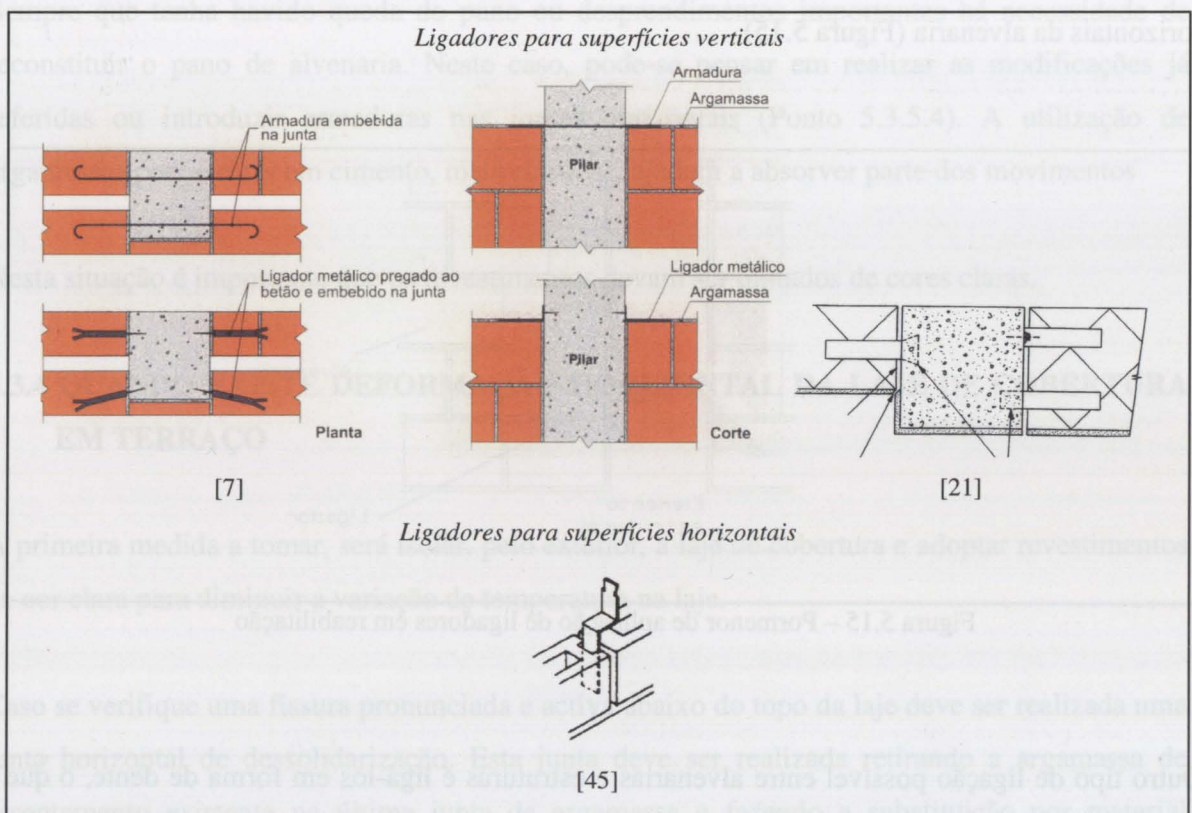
Ligadores metálicos para realizar a ligação entre alvenaria e elementos de estrutura
